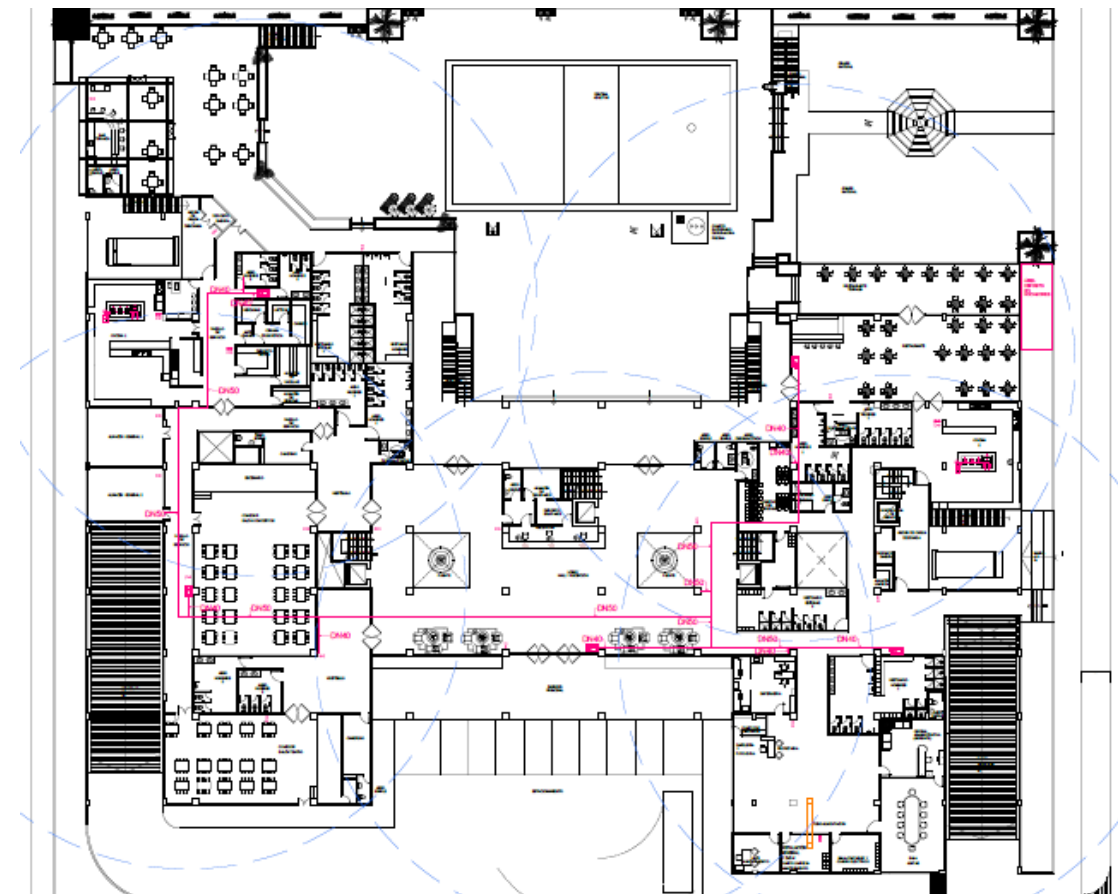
Ubicación BIEs y alcances. Planta Baja. Planos del proyecto
